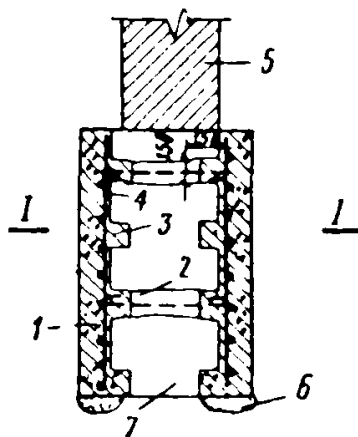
Усиление ленточных фундаментов железобетонной рубашкой
